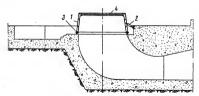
Установка облицовки конуса отсасывающей трубы.
